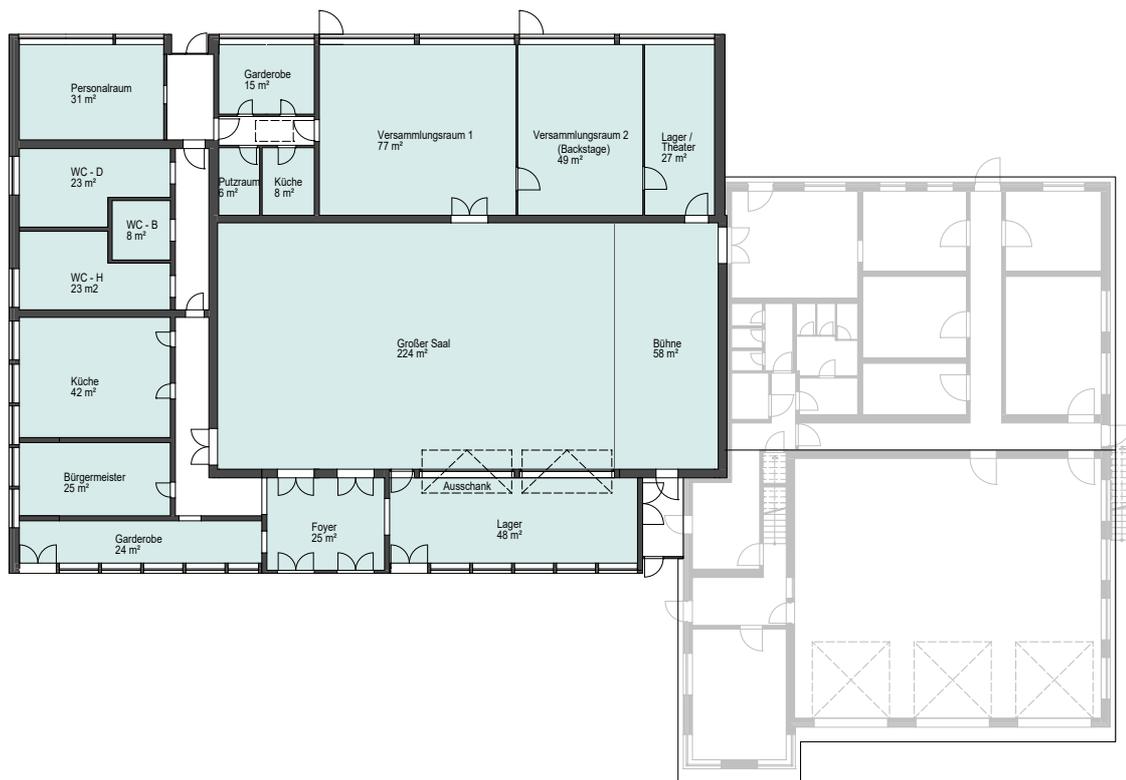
Grundriss Umbau der alten Turnhalle zu Dorfhause (ohne Maßstab)
